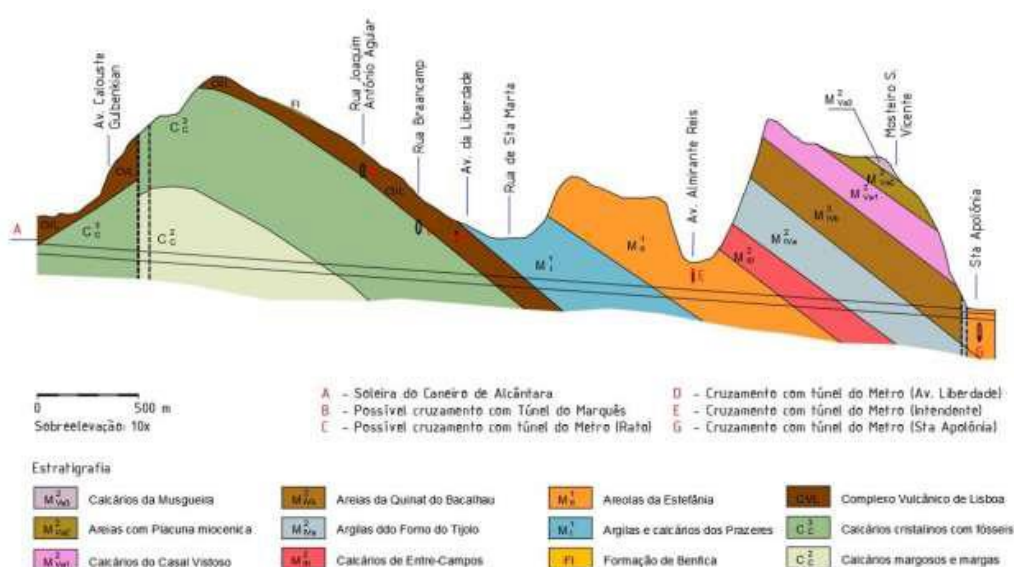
Perfil geológico retirado do Plano Geral de Drenagem de Lisboa [1].
